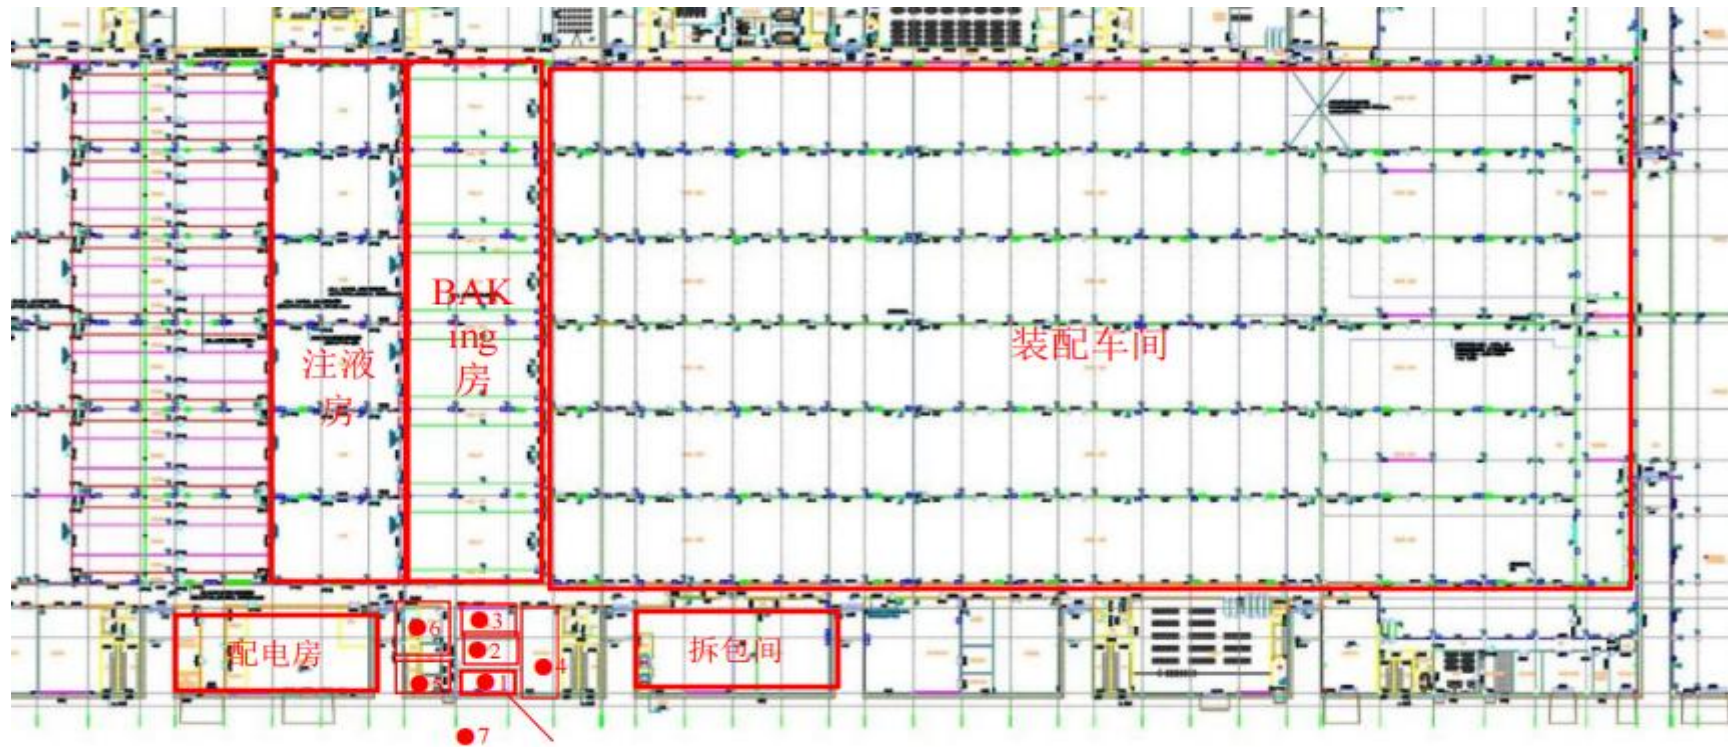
宁德蕉城时代新能源科技有限公司总平面布置图
